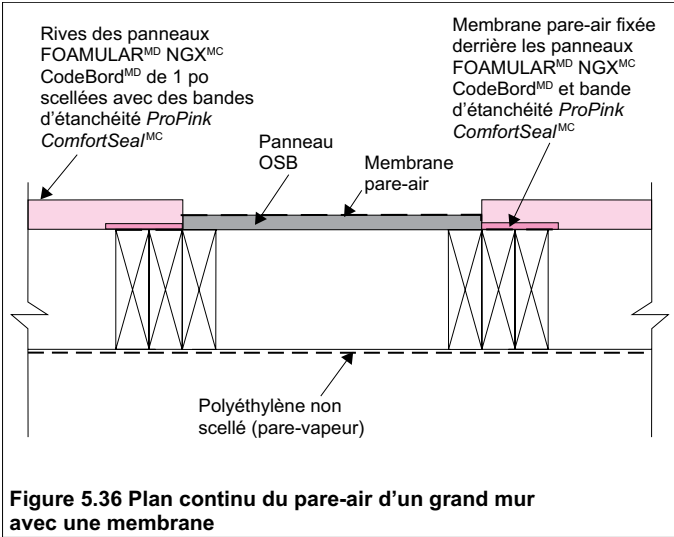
Plan continu du pare-air d'un grand mur avec une membrane
